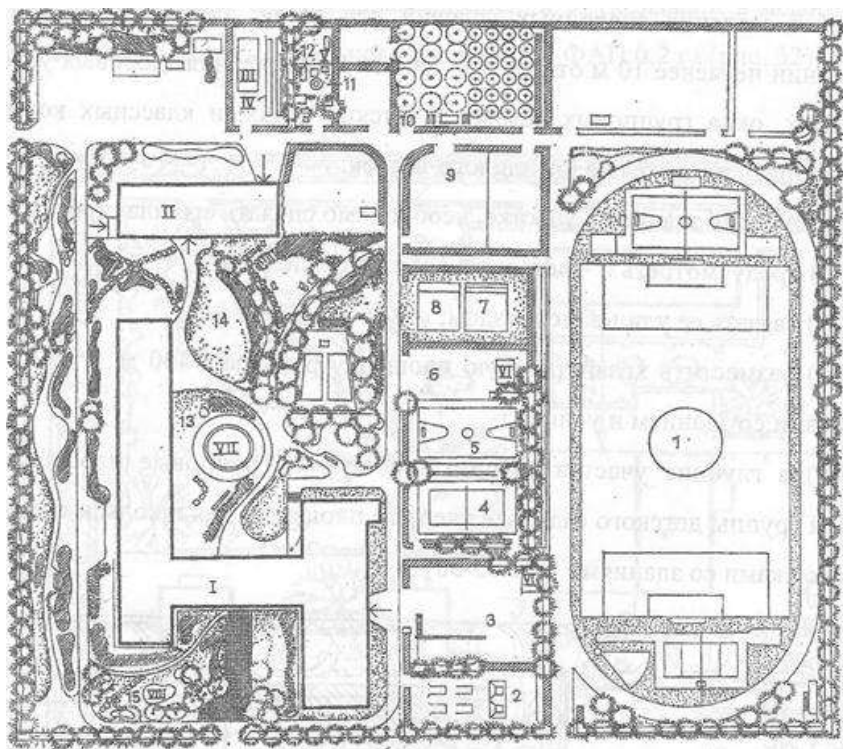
Схема генерального плана общеобразовательной школы на 960 учащихся:
